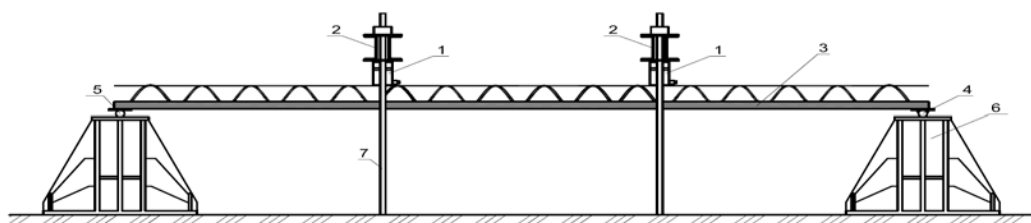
Стенд для випробування залізобетонних плит незнімної опалубки ПО–4
